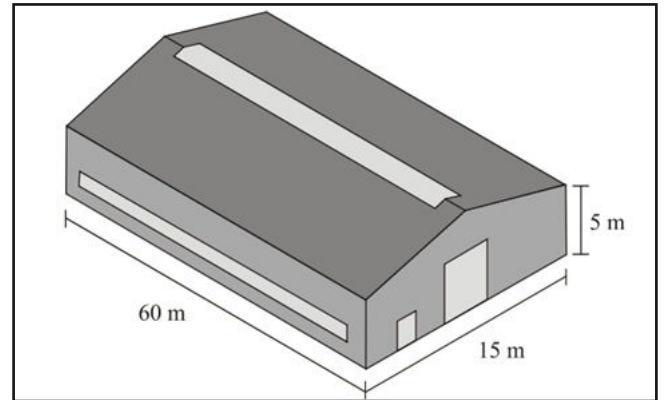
Beispielabmessungen einer bauforumstahl-Typenhalle
